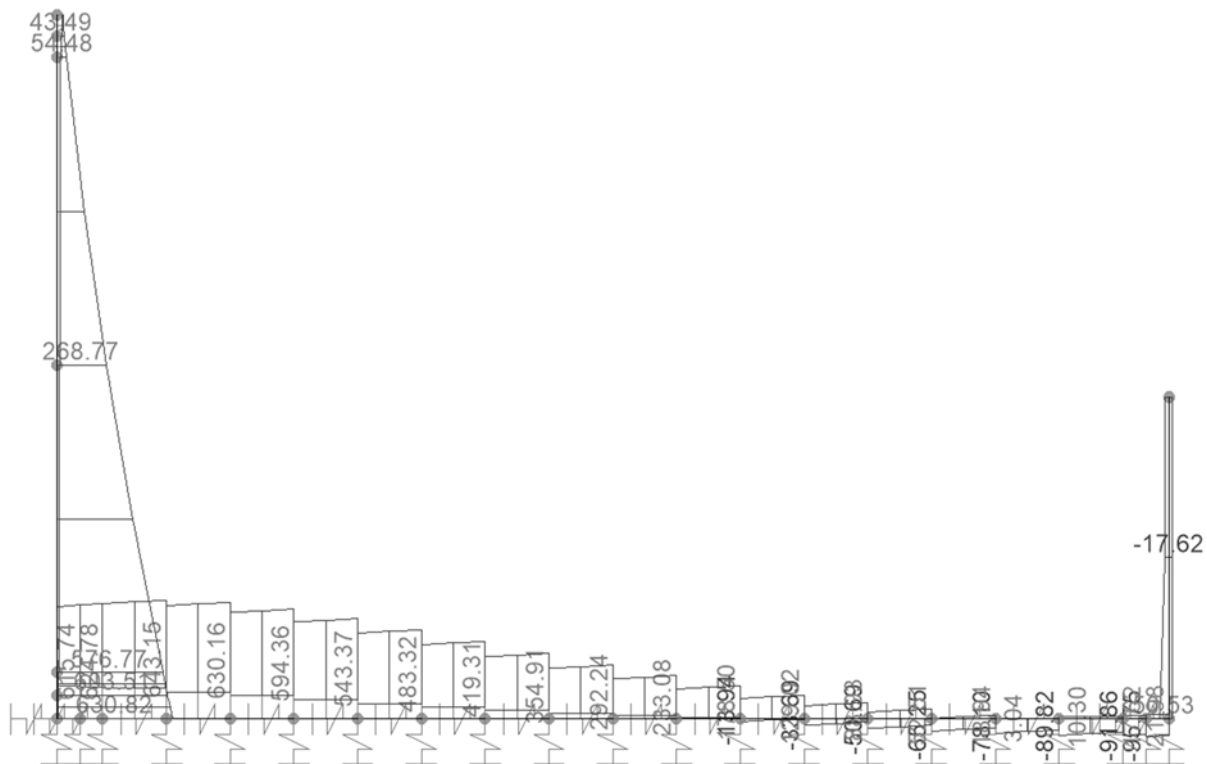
SLV – Piedritto e platea di fondazione – Tagli Ved
